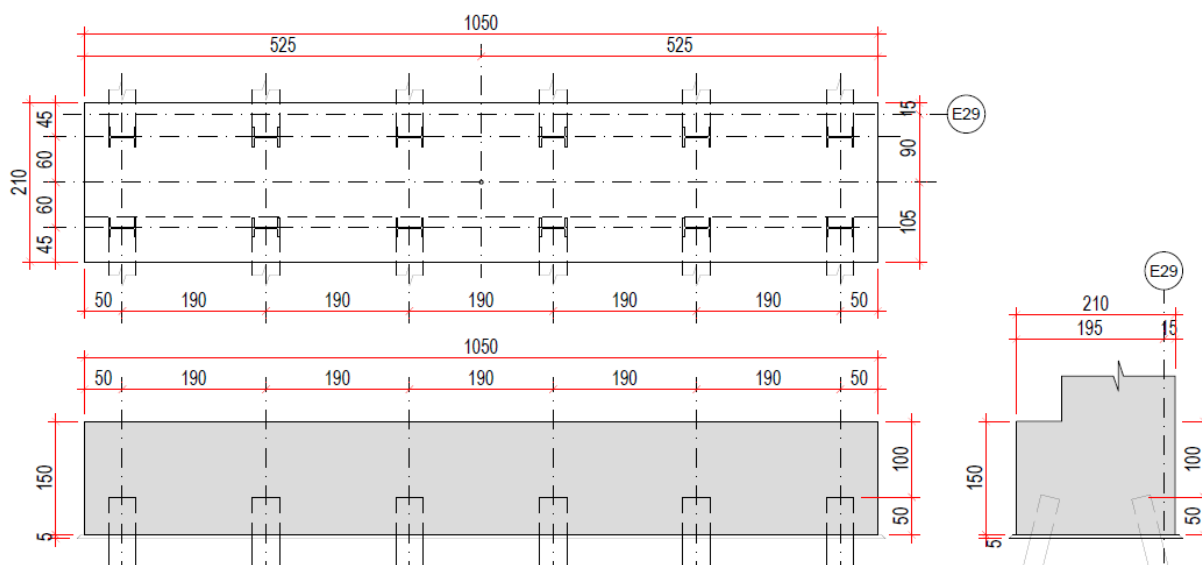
DETALHES DO BLOCO DE FUNDAÇÃO EIXO E1 E E29
